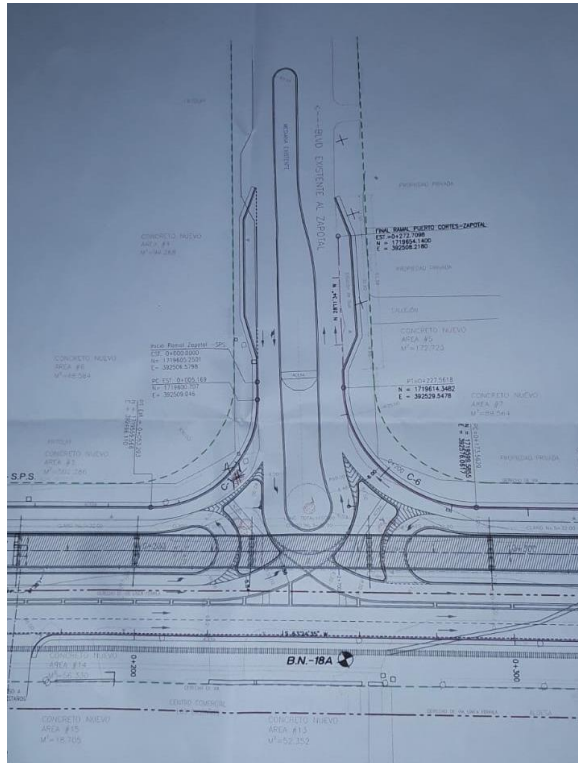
Plano en planta del Ramal Cortés-San Pedro Sula
